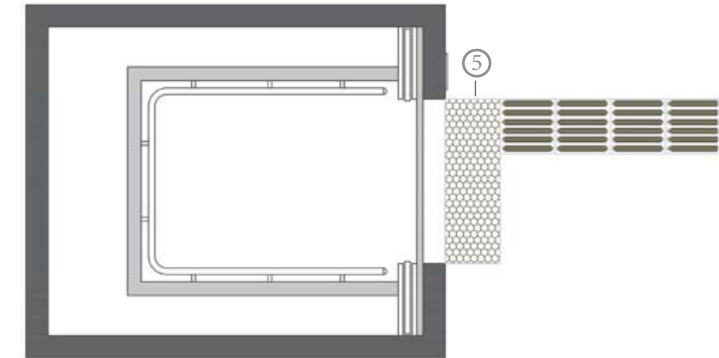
3 Franja de advertencia táctil para elevador - Planta
